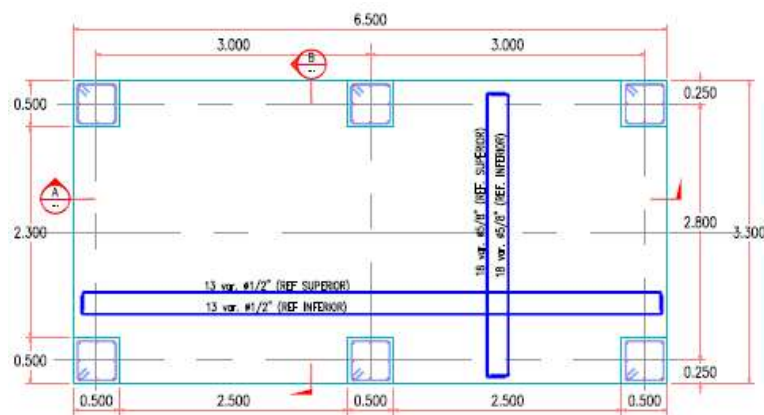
Detalle en planta de cimentación para Seccionador de barra
